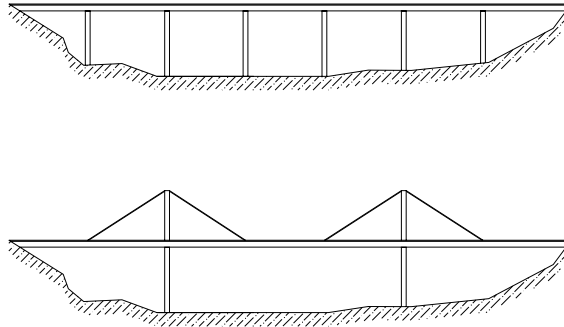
Idea de la substitució de piles per cables. (Font: Elaboració pròpia).
